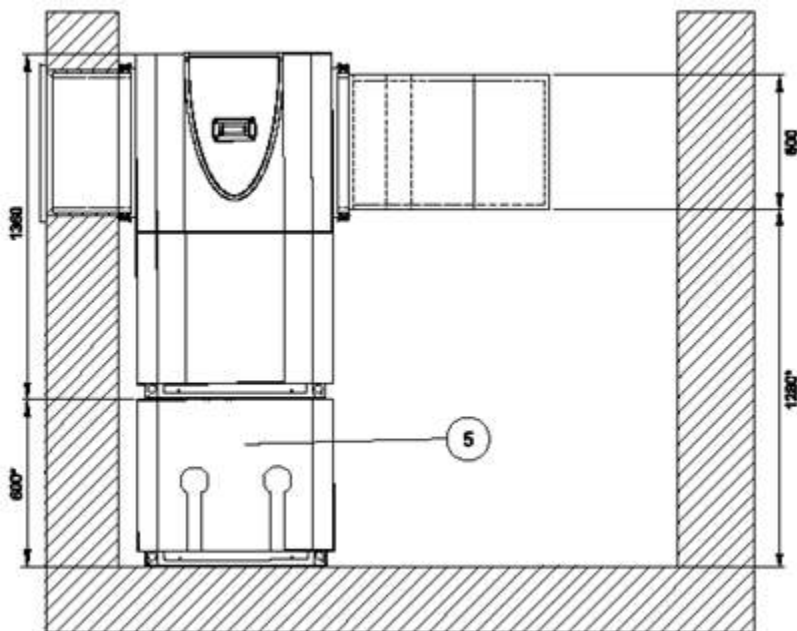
Vue de face - LI 11TES (installation murale - conduit d'air, côté refoulement)
